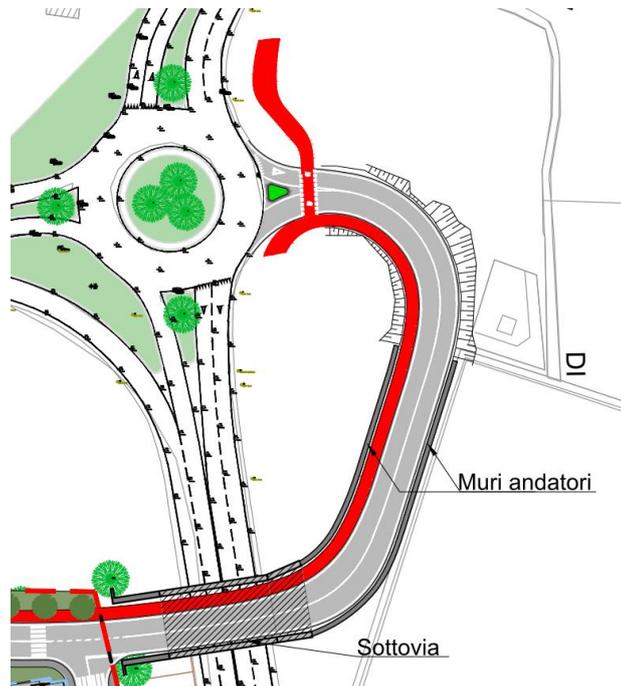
Ramo di accesso est dalla rotonda esistente di via Cadorna
